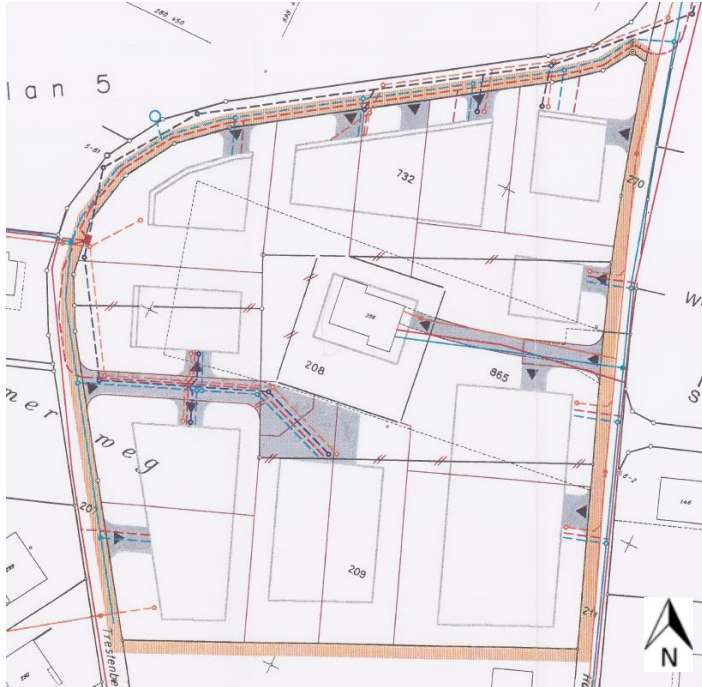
Planausschnitt GP 'Trestenberg - Hansroren'
